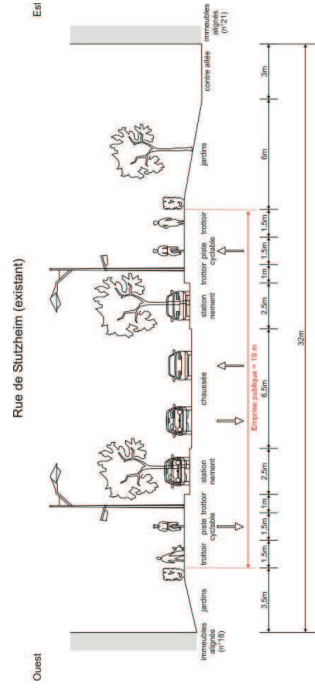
situation existante. Coupe sur la rue de Stutzheim.
